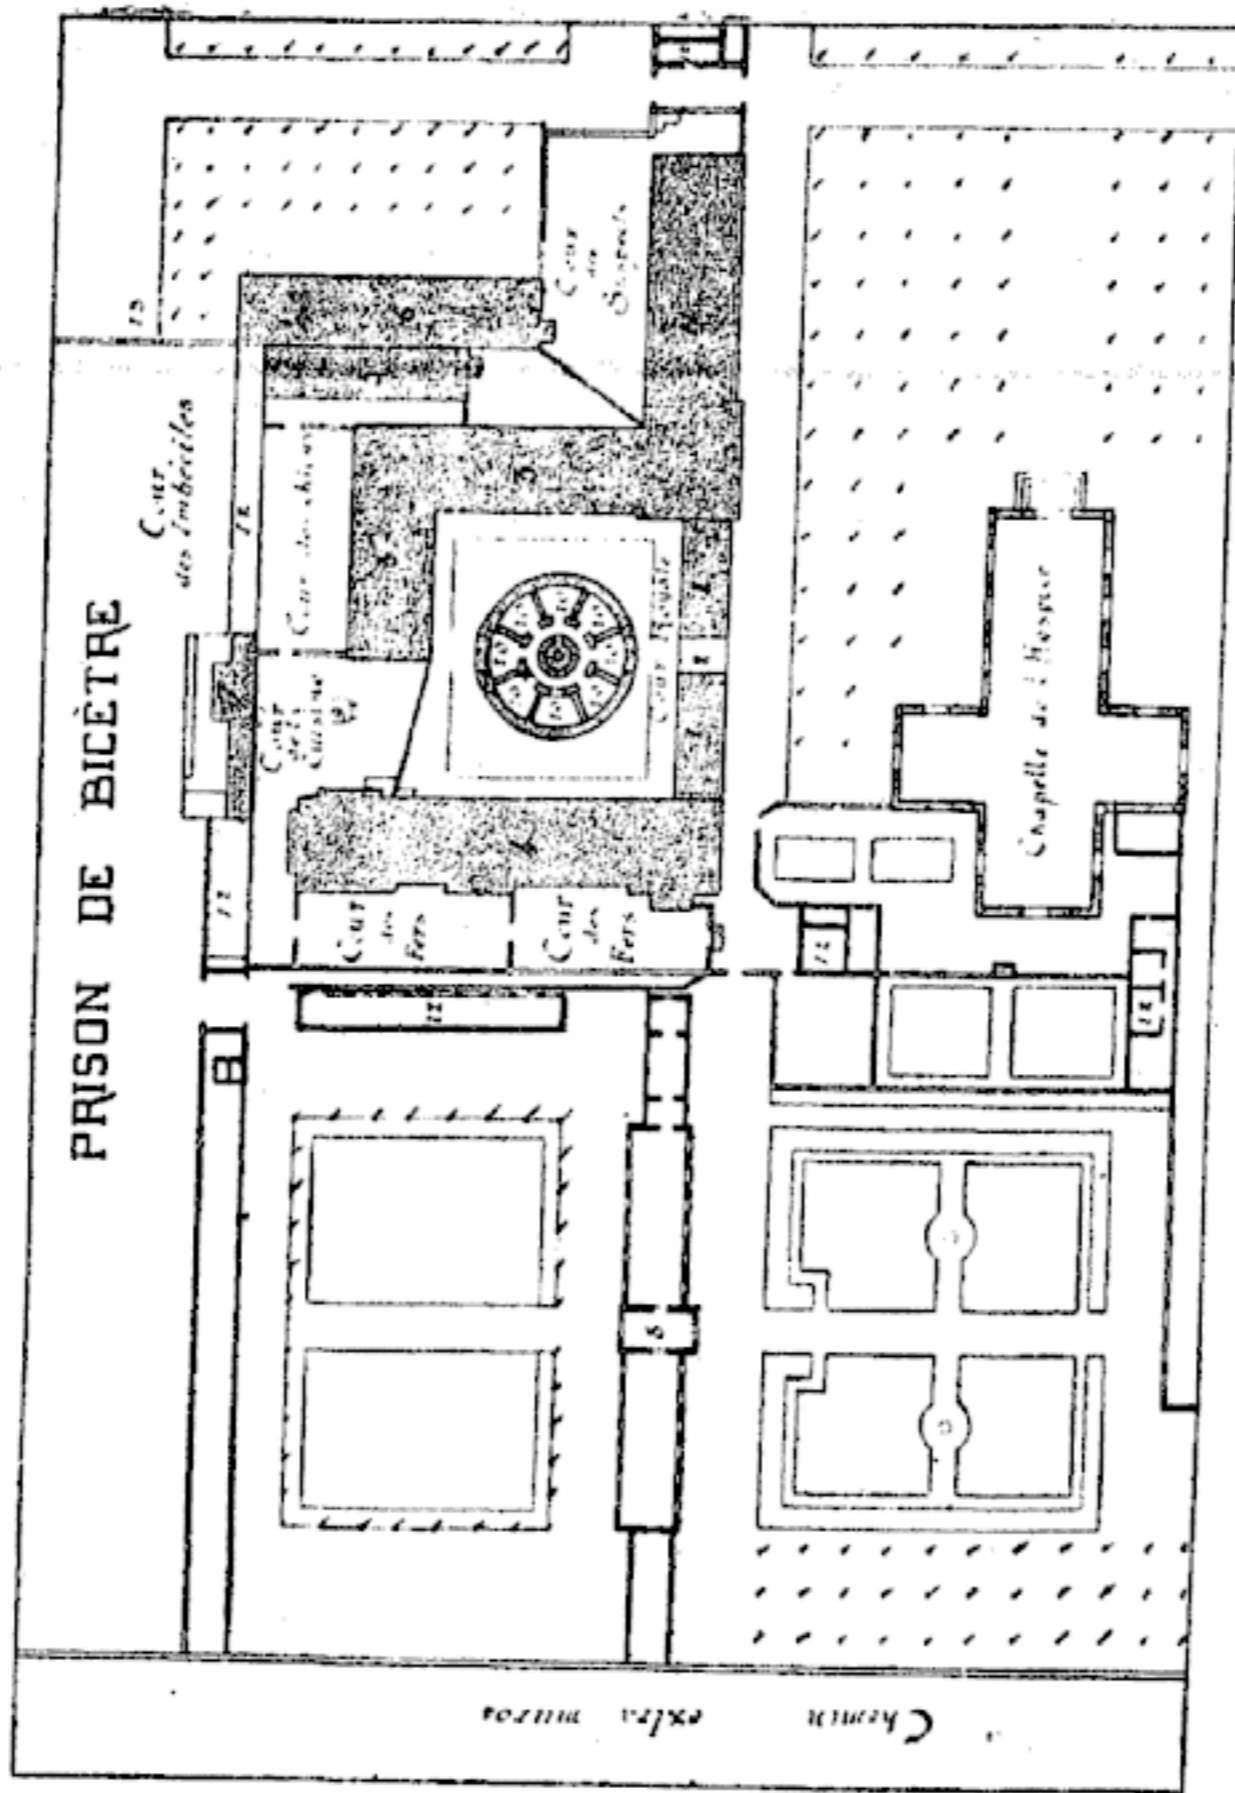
PLAN DE LA PRISON DE BICÊTRE
